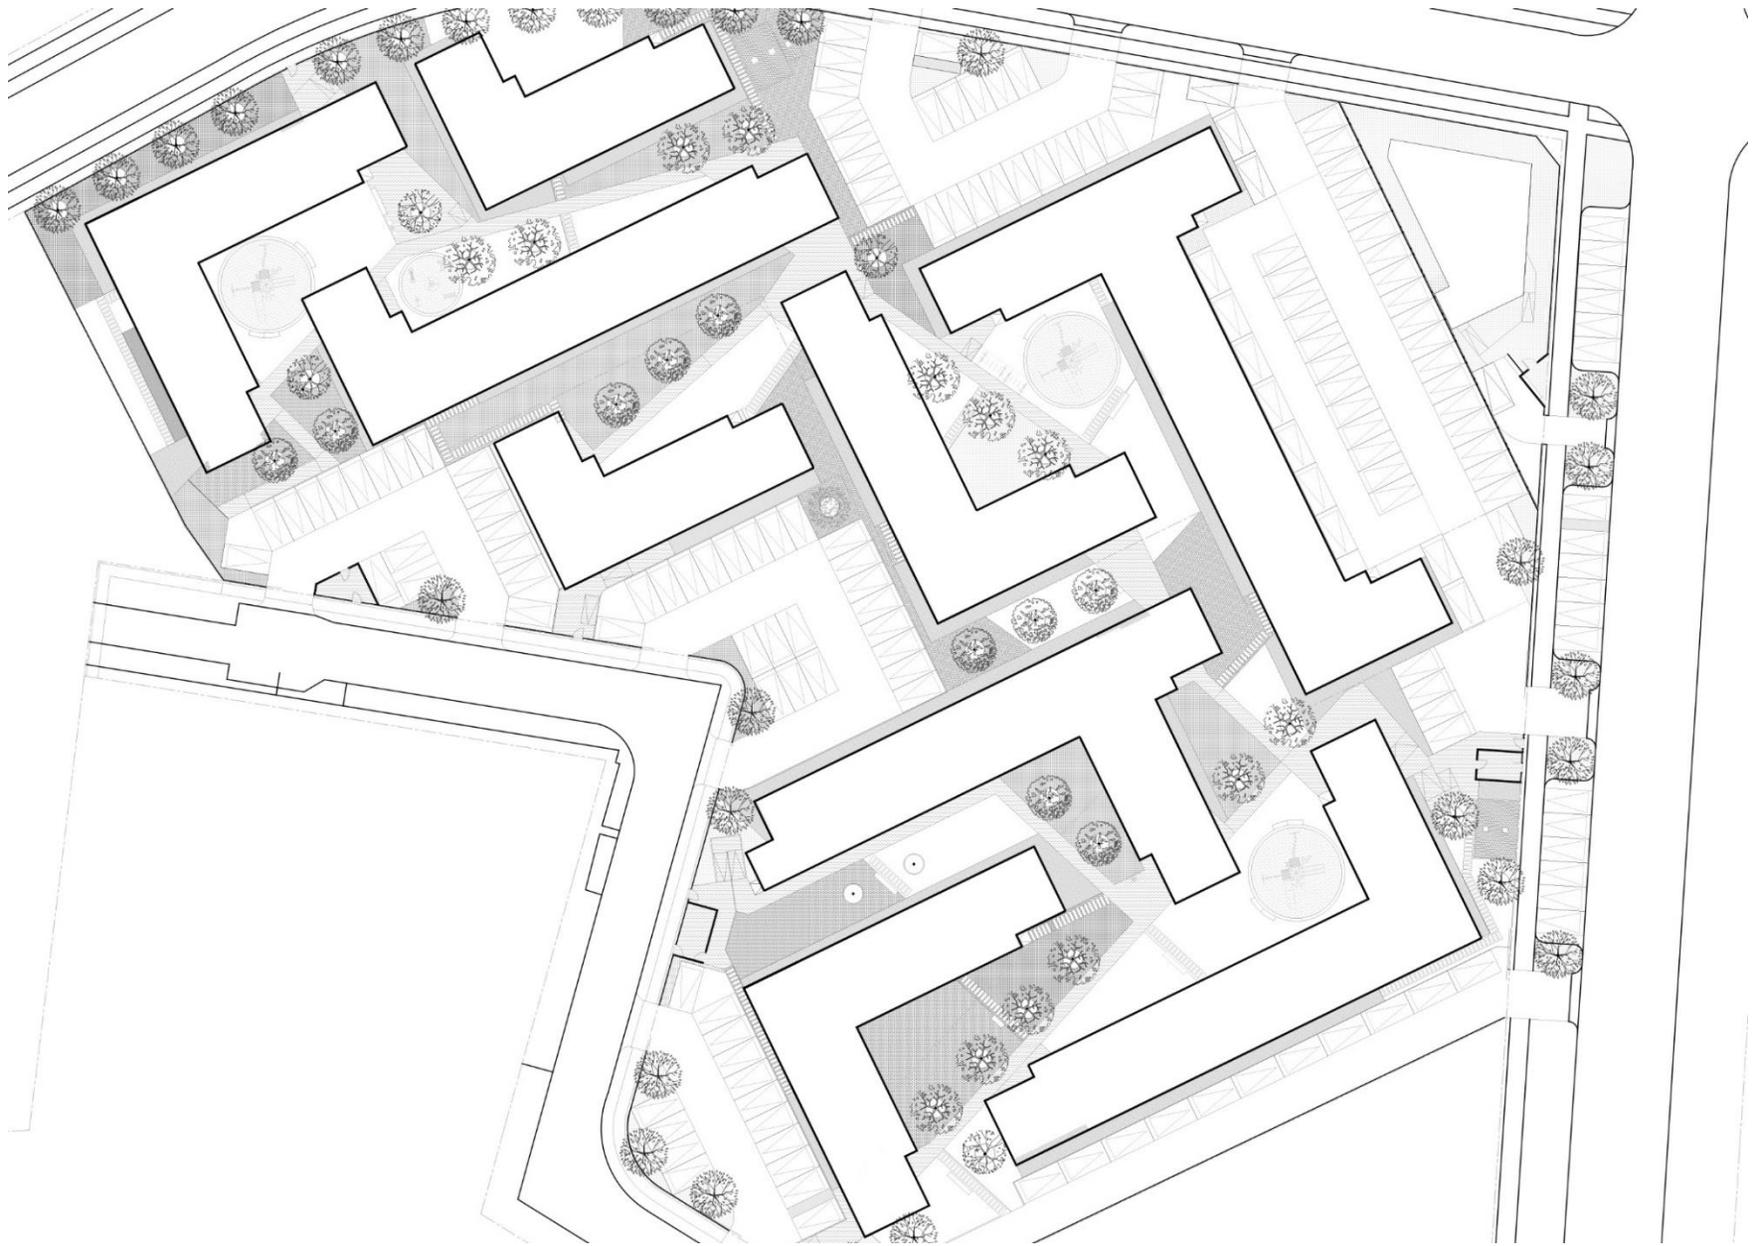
Plano loteo conjunto Villa Parque Lo Prado, escala 1:750. Fuente: Elaboración propia.
